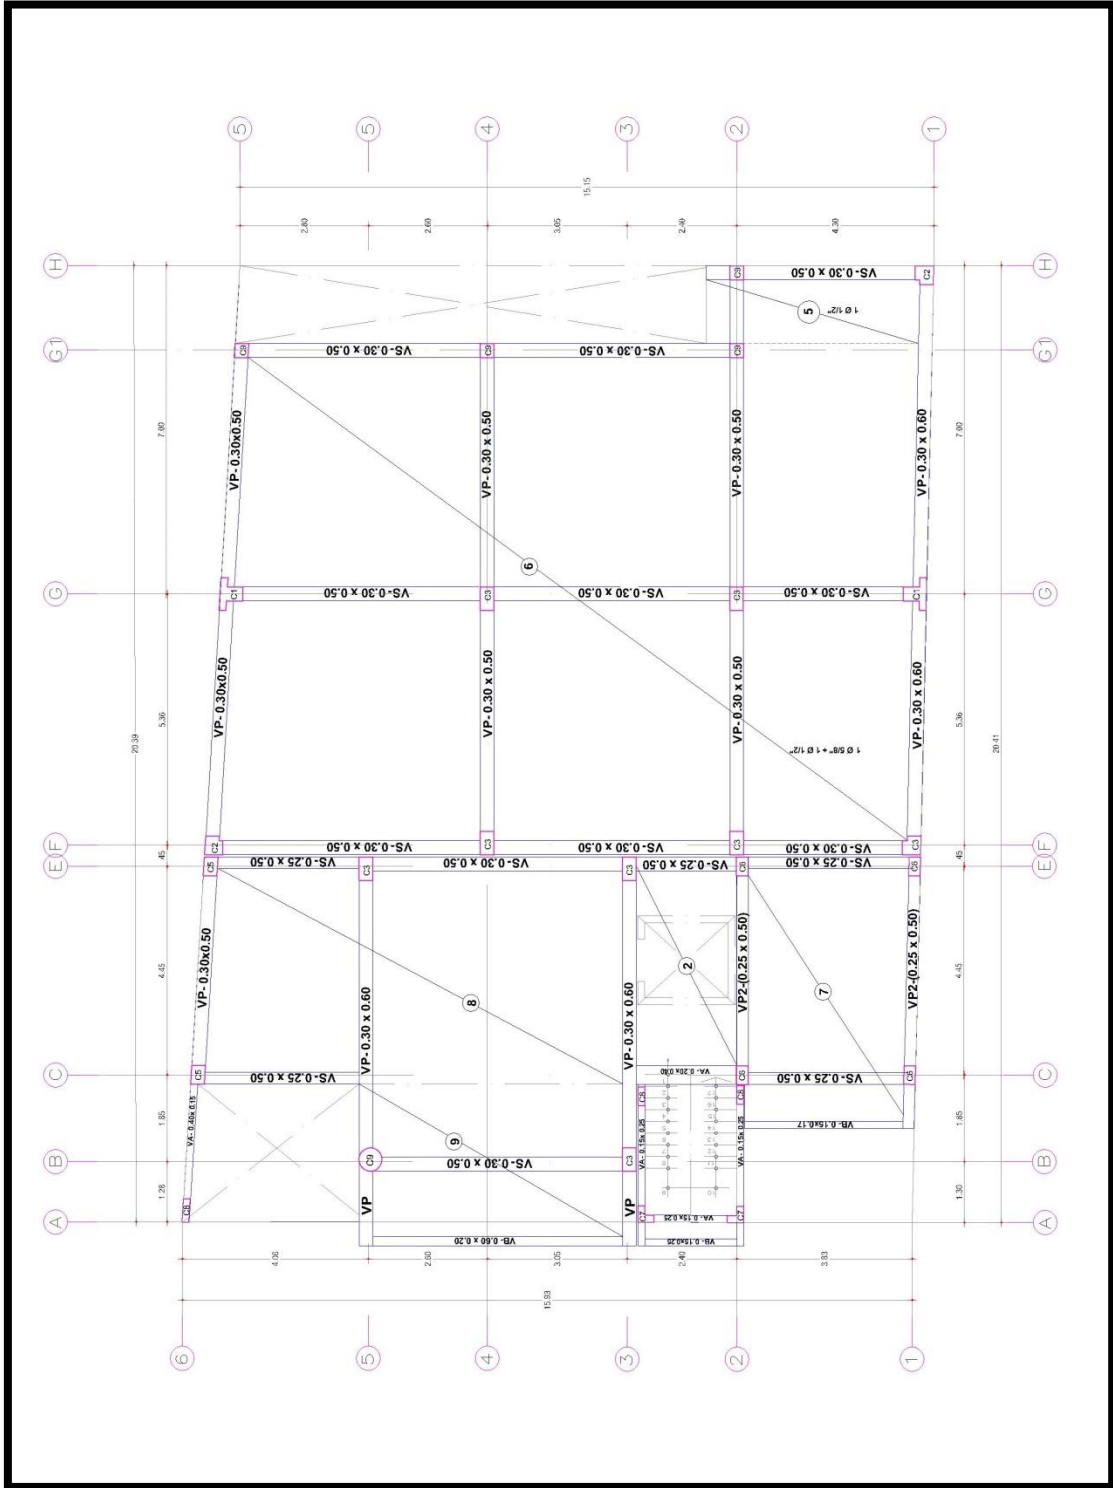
Sistema Estructural del Edificio (Piso Típico)
